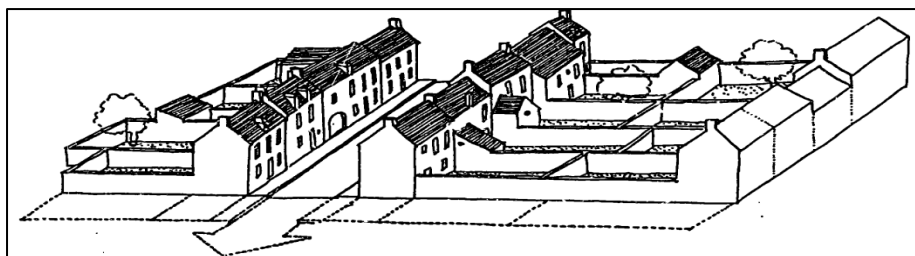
Tissu urbain avec construction en mitoyenneté le long de la rue
